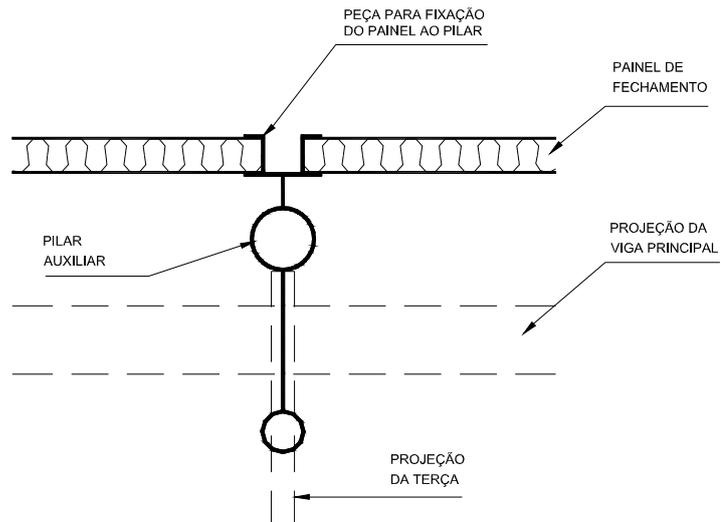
Detalhe da fixação dos painéis no pilar tipo 1.
